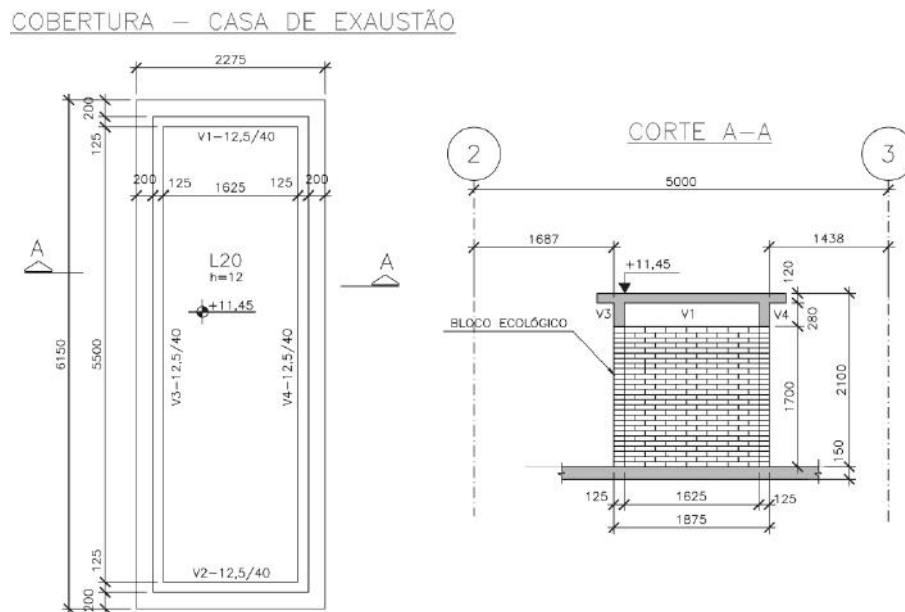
Estrutura da casa de exaustão – Dimensão em mm e elevação em m
